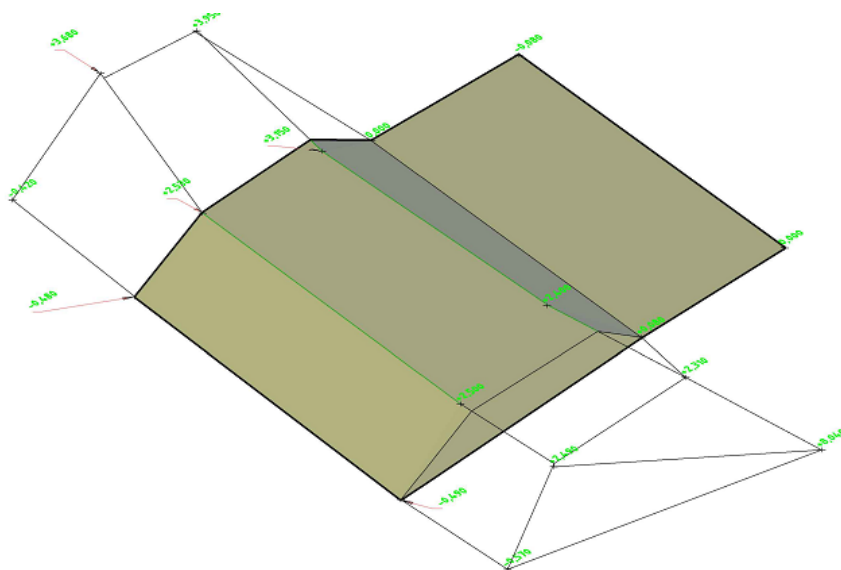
Съемка загрузки плиты защитного экрана грунтом при проведении испытаний
